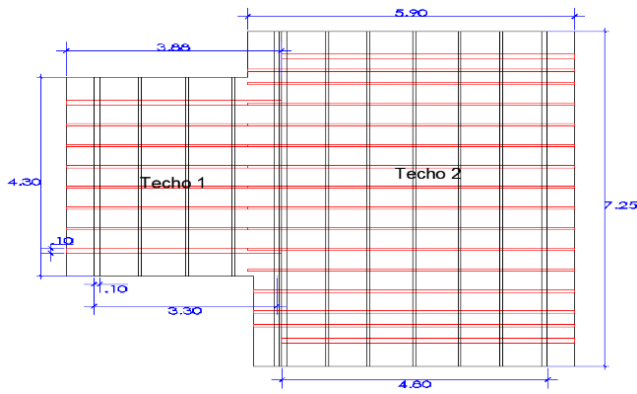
Dimensiones de los techos en una sola vertiente en vista en planta de la vivienda modular (Fuente: Propia)
